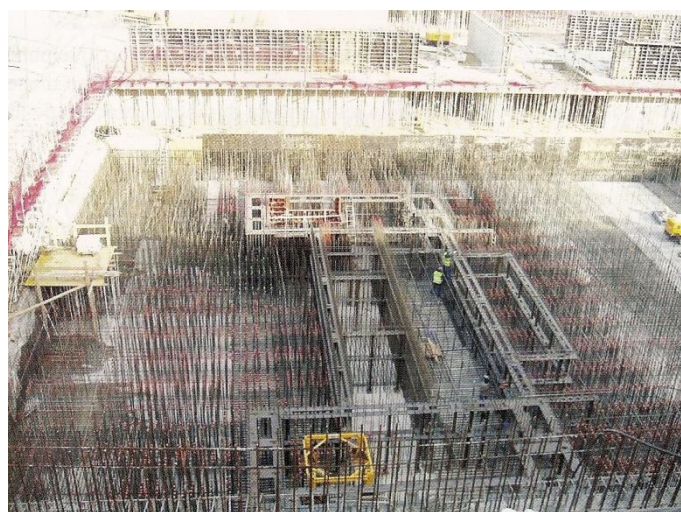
Vista geral de laje armada com juntas de rede de metal distendido na Torre Caja Madrid (Urzaiz, 2006)
